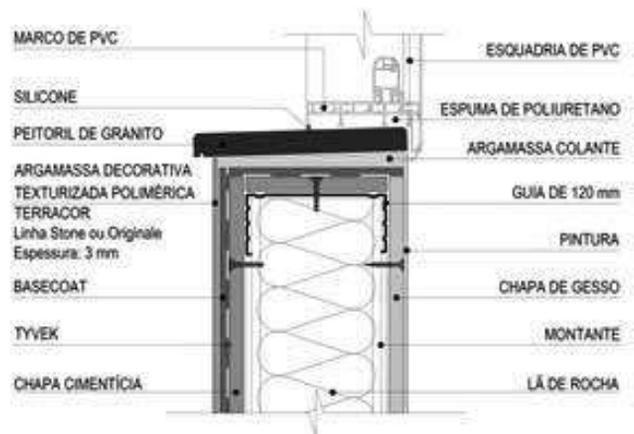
Detalhe do encontro entre esquadria e LSF com placa cimentícia na posição do peitoril. (Acervo Inovatec Consultores)
